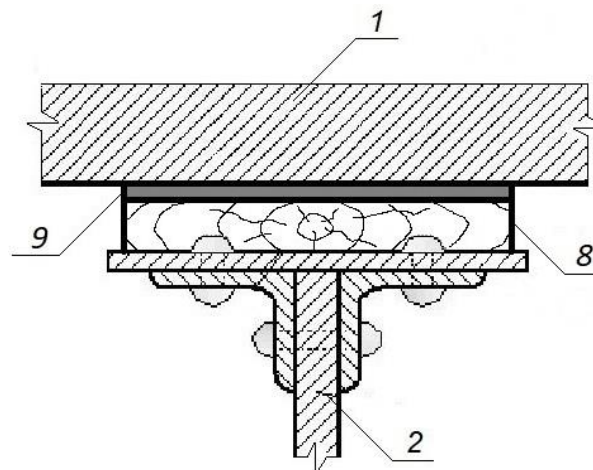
Безбаластне мостове полотно на залізобетонних плитах:
